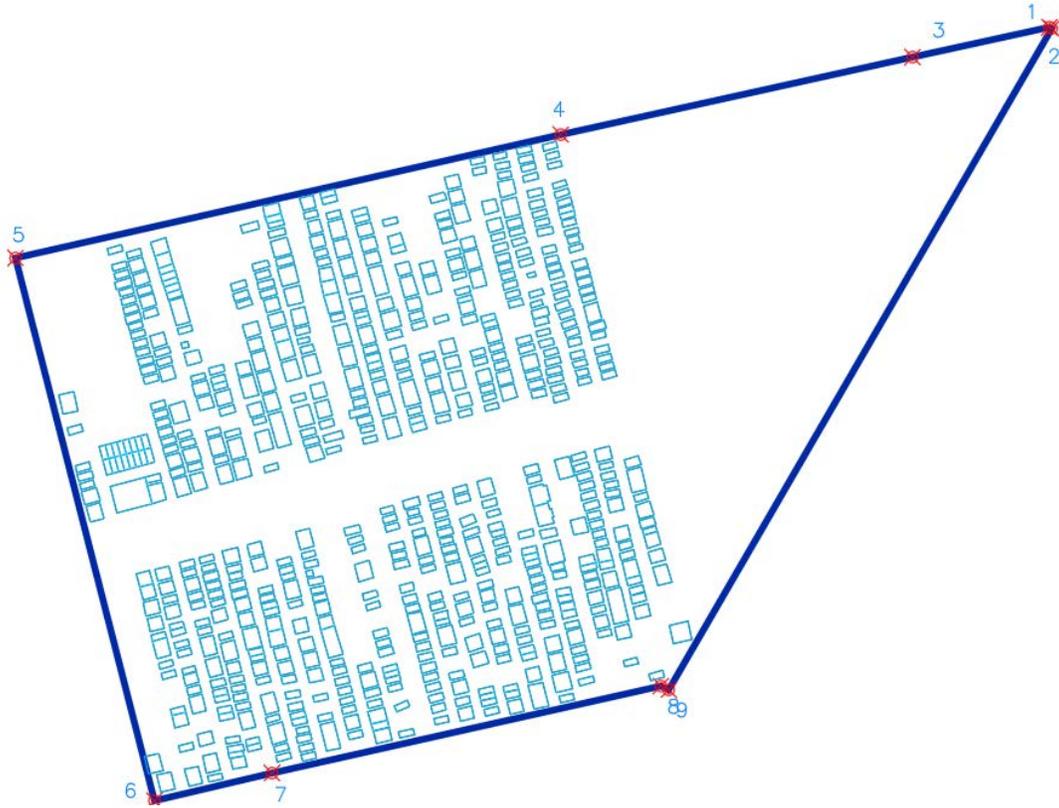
Planimetría con Polígonos de Gavetas. Cementerio Pegueros
